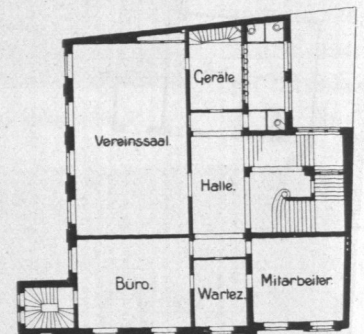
Volksheim Billhorner Mühlenweg, erstes Obergeschoß, Grundriß.
